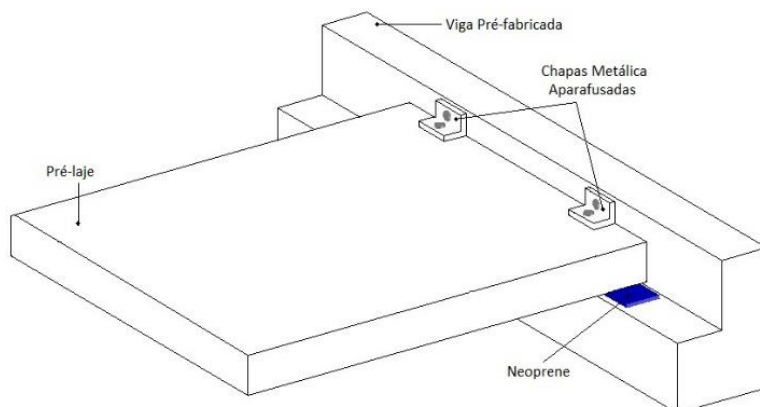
Ligação Laje – Viga de extremidade com chapas metálicas aparafusadas
